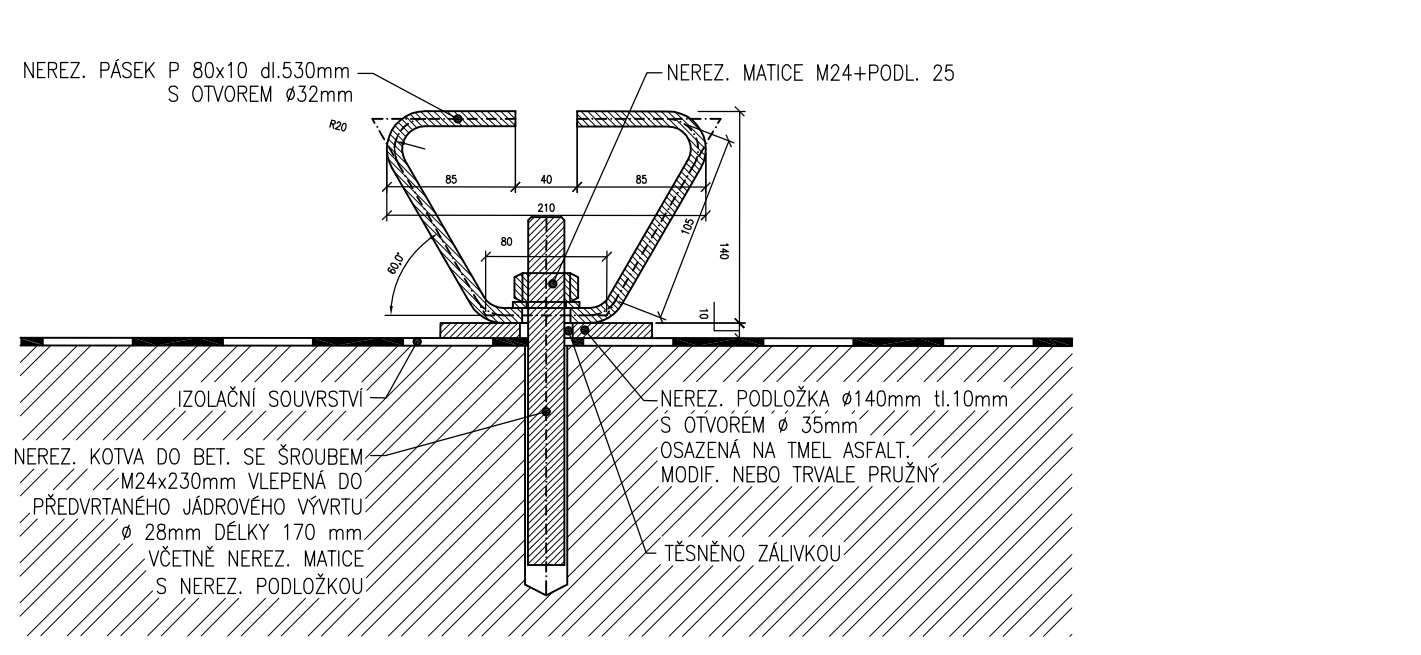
DETAIL ÚPRAVY DILATAČNÍ ŘÍMSY (B)
